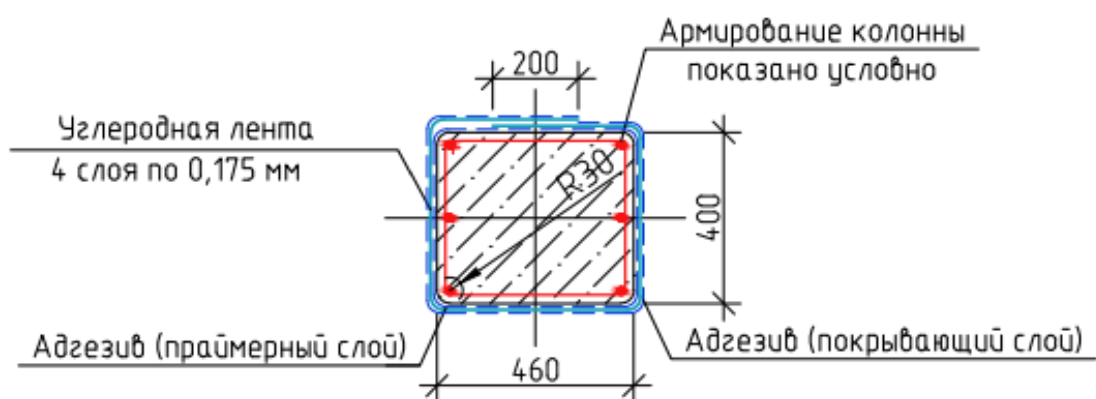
Схема внешнего армирования углеволокном разрез А-А
